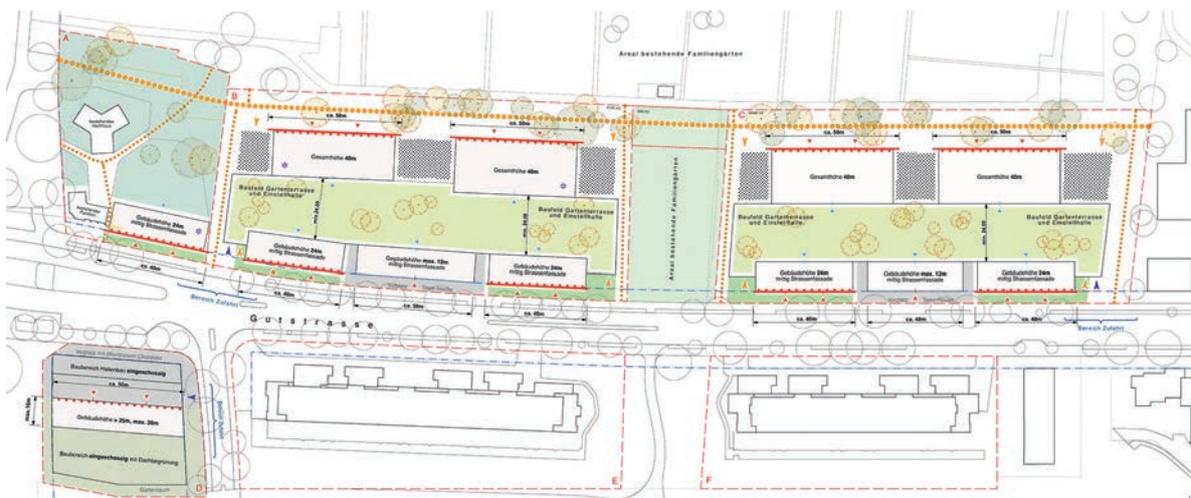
Plan «Masterplan Gutstrasse», Studio Märkli ¹
